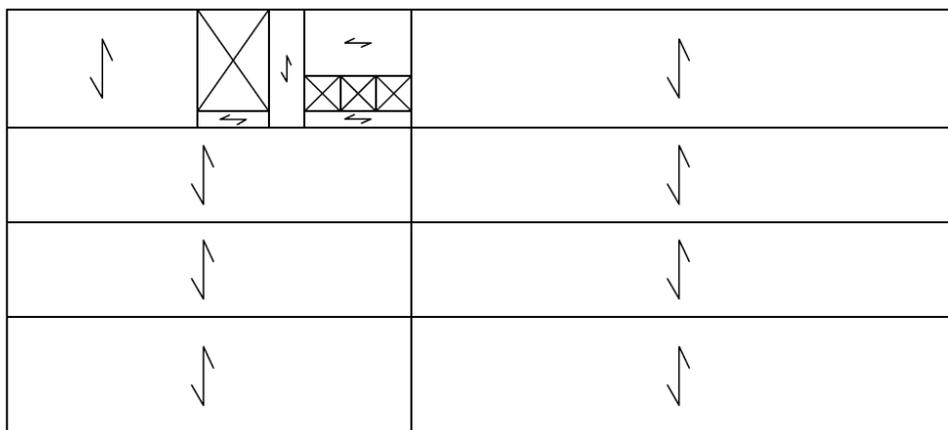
Distribución vigas forjado viguetas y bovedillas.
